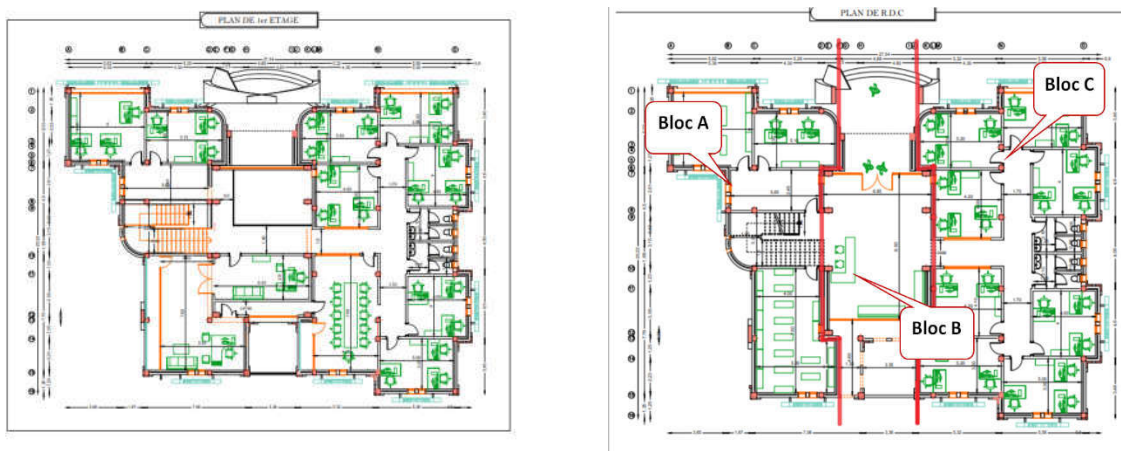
Plan de R.C.D et 1^{er} étage
